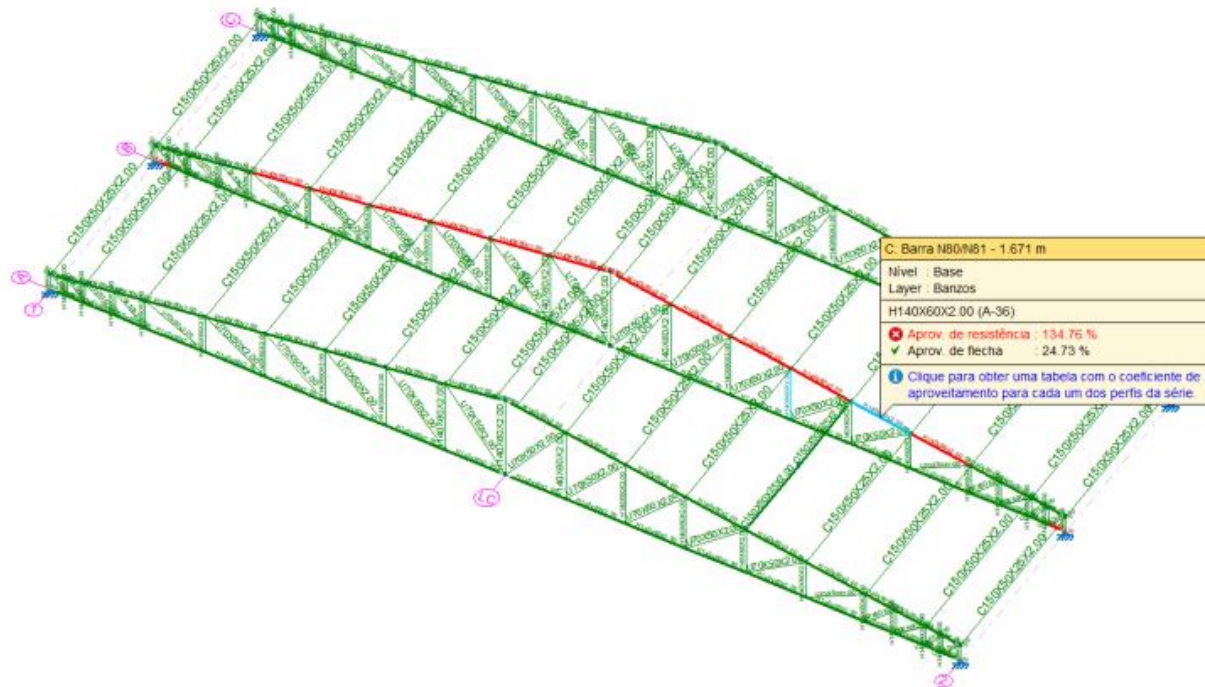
Vista lateral da estrutura metálica do galpão na LONGPING HIGH-TECH, Cravinhos, SP, 2021.
